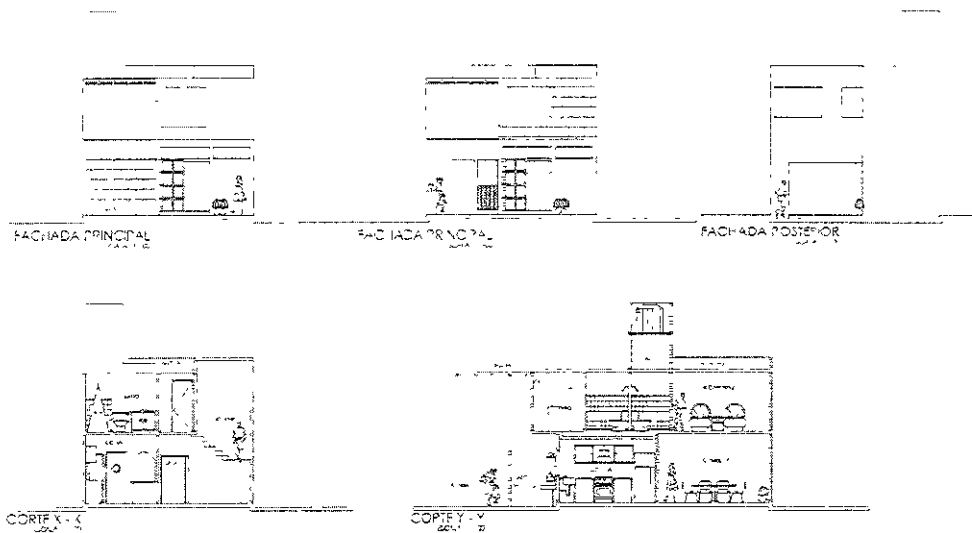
Fachadas y cortes, proyecto Casa habitación
